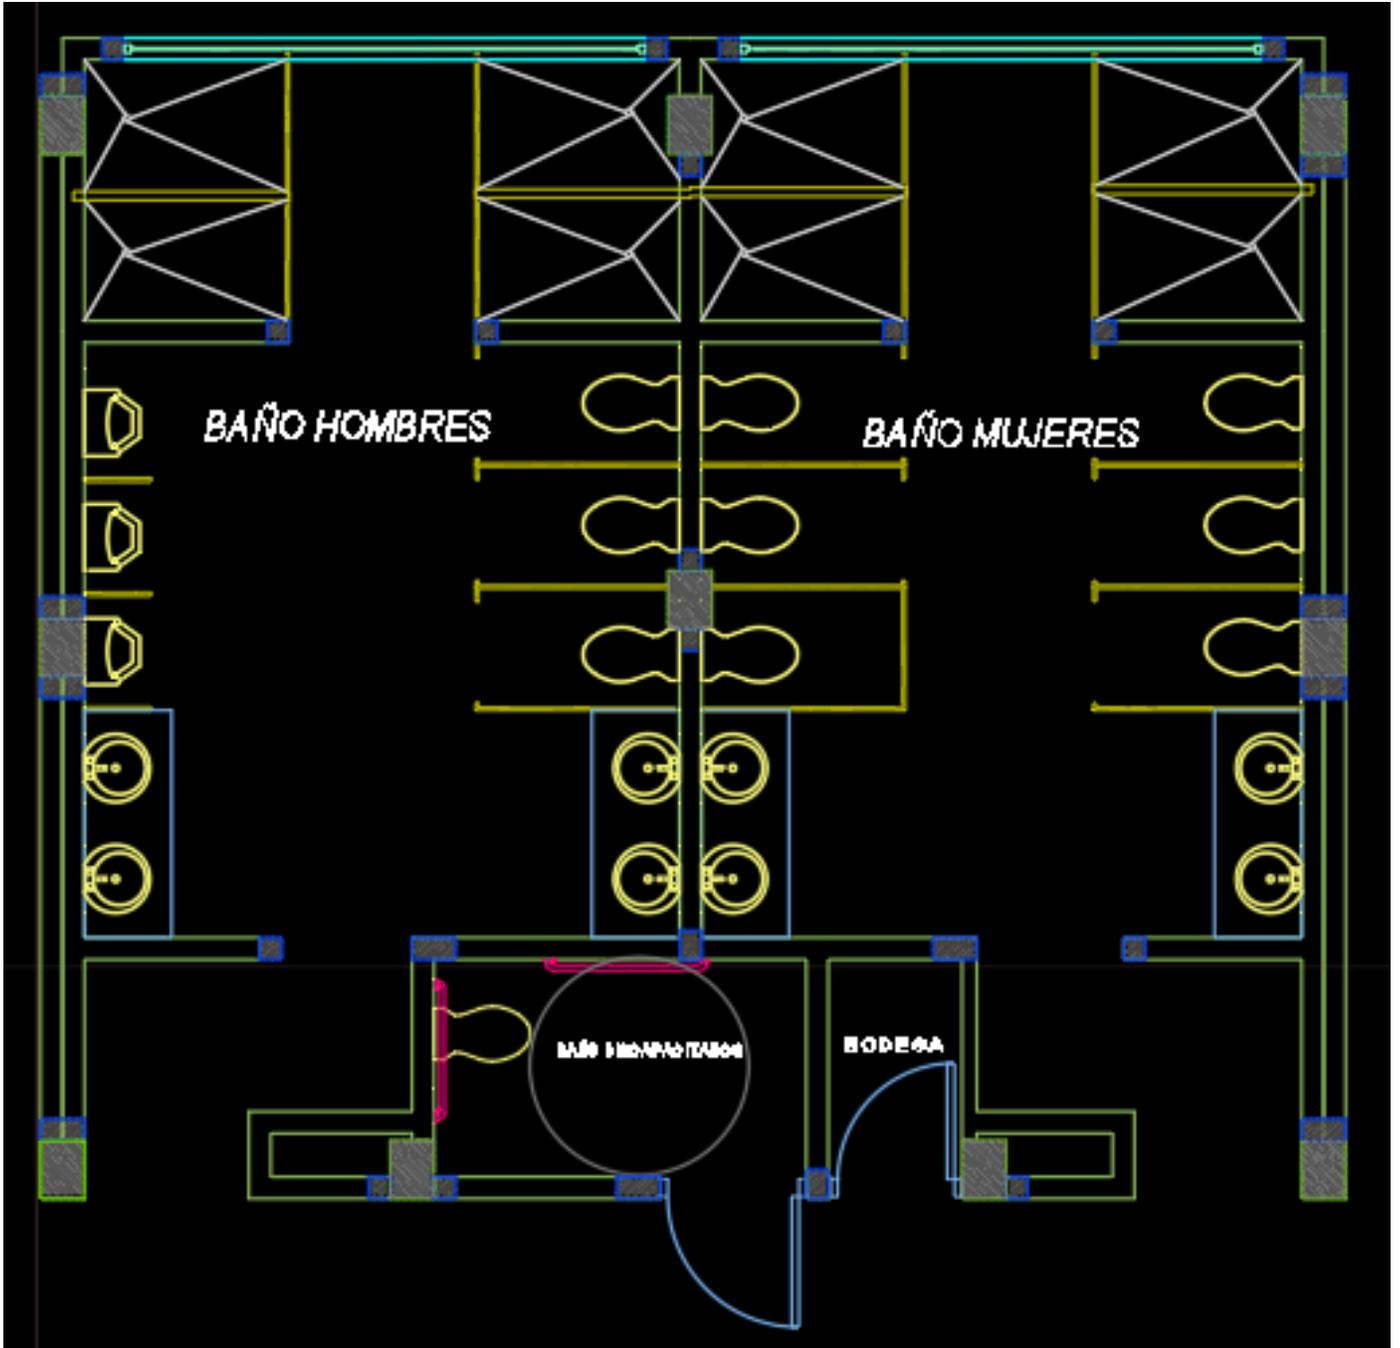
Plano planta de baños bloque educativo 1ra versión, Planos Camilo Torres
